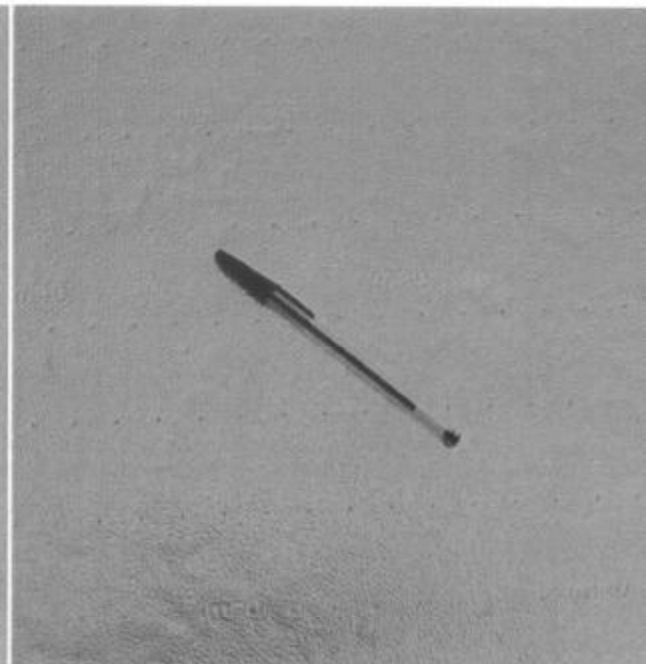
Trecho da face da placa – face oposta à da incidência sonora.
